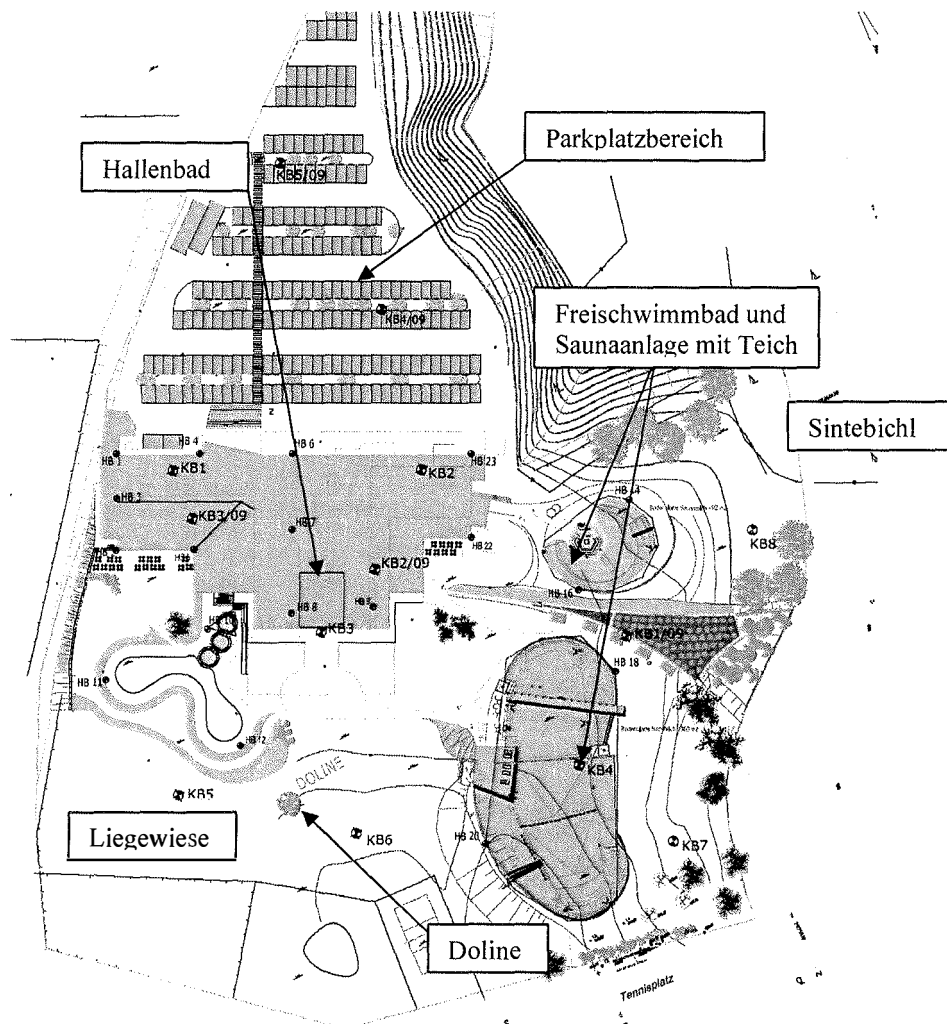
Ausschnitt Lageplan (Plangrundlage „E007 LP01“ Architekturbüro Walch, 2009)
